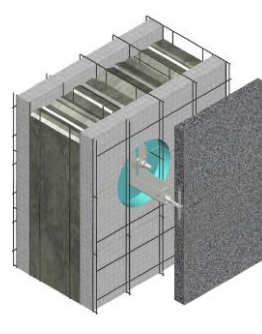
Ancres mécaniques pour la pierre naturelle ou le revêtement
